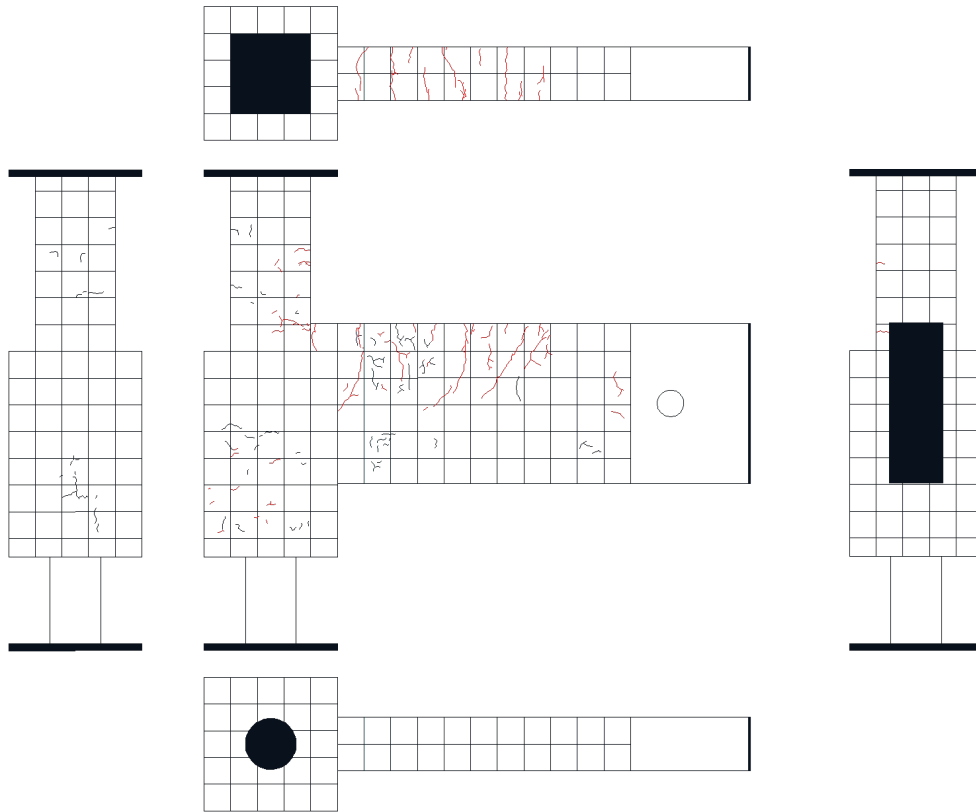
試験体 D-1 ひび割れ状況 (2Cycle)
